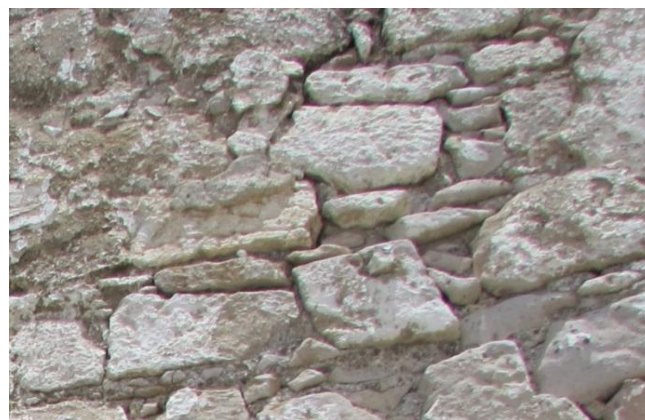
72 Mampostería irregular de piedra blanca en fachadas interiores de casamatas
